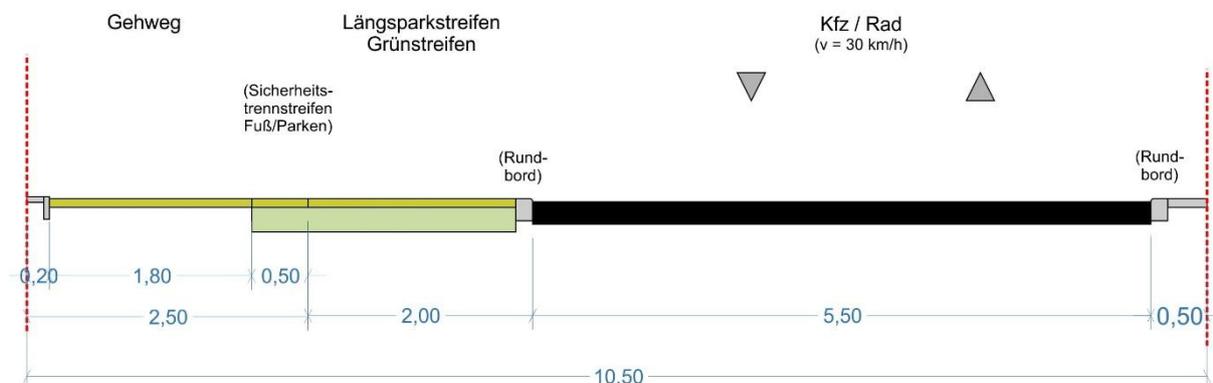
Regelquerschnitt Straßentyp S3 – Sammelstraße (Blick nach West)
